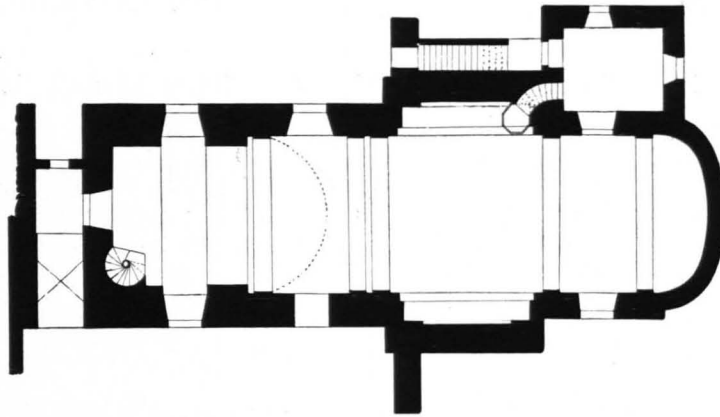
Reinprechtspölla, Pfarrkirche, Grundriß 1:300 (S. 104)
